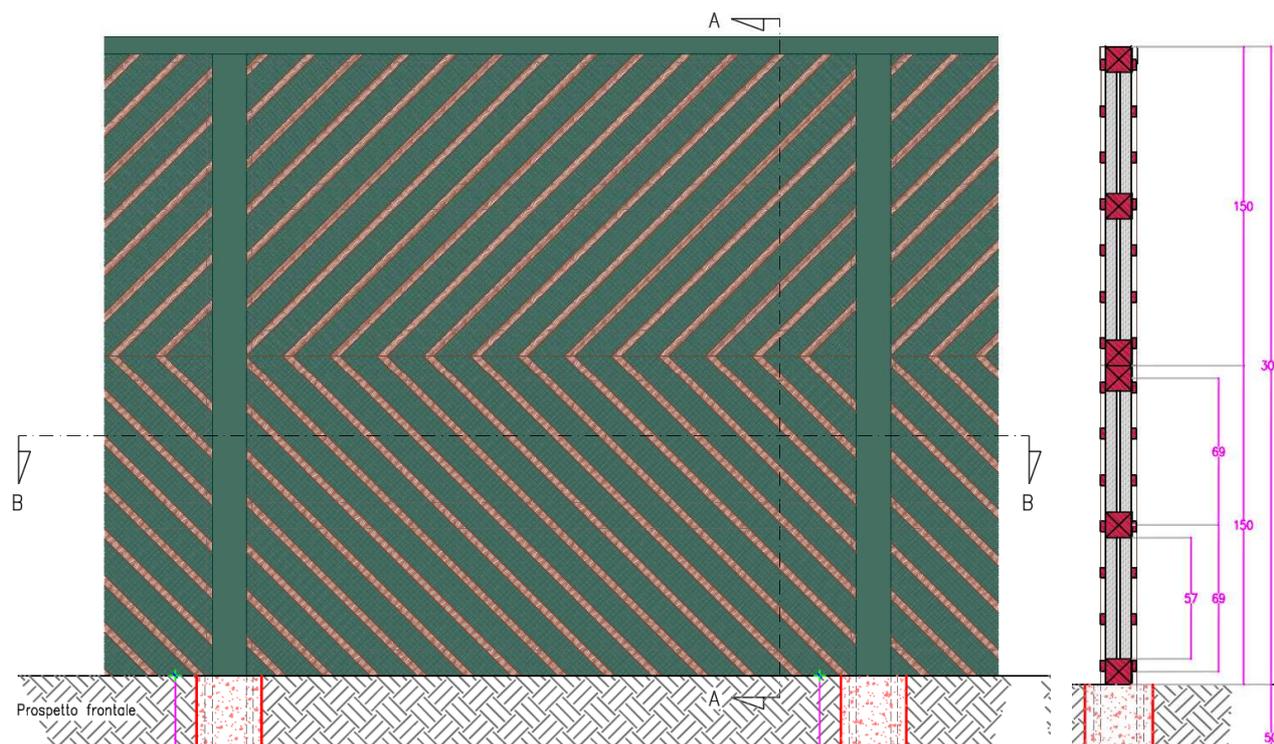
BARRIERA ACUSTICA IN LEGNO: VISTA PROSPETTICA E SEZIONE VERTICALE
